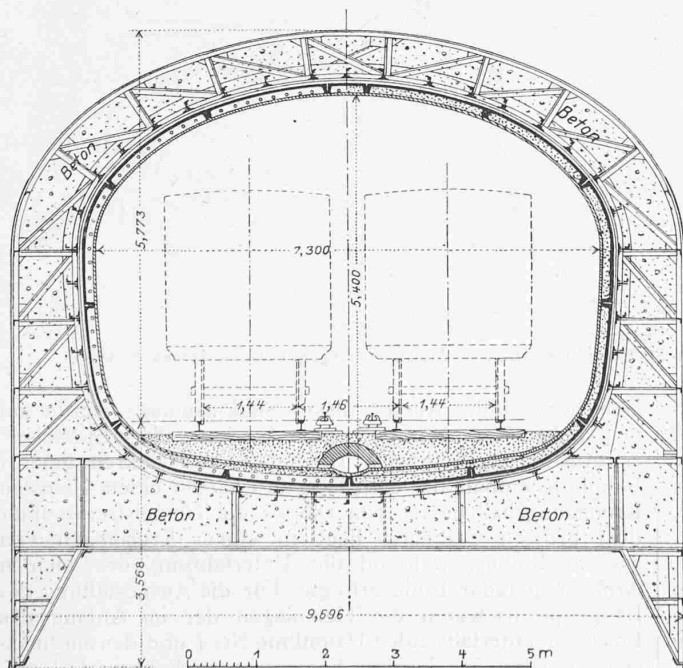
Querschnitt der Caisson-Tunnelstrecke. — 1 : 100.
